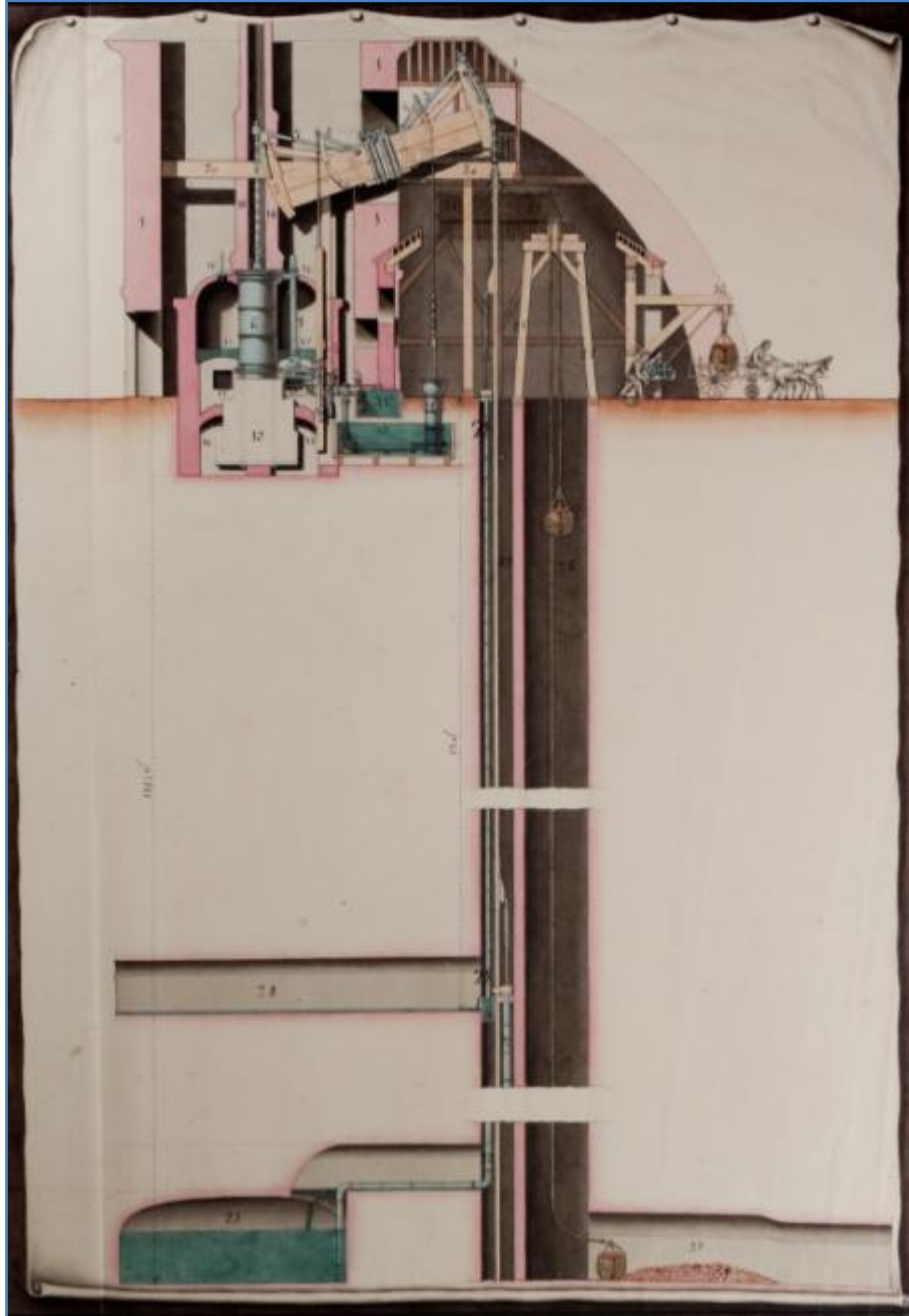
Vistas de las tres máquinas del Plano Nº 12.
